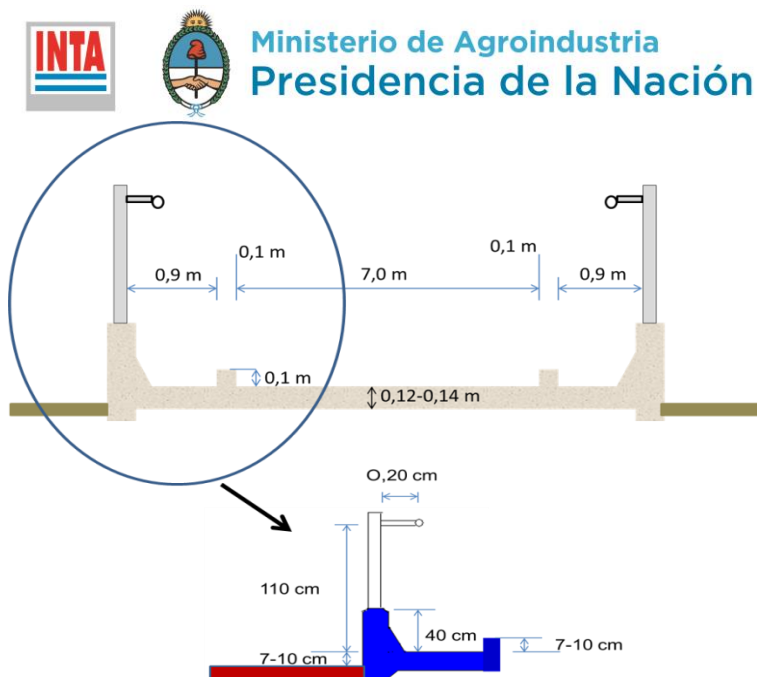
Detalles constructivos del PUM y dimensiones recomendadas.
